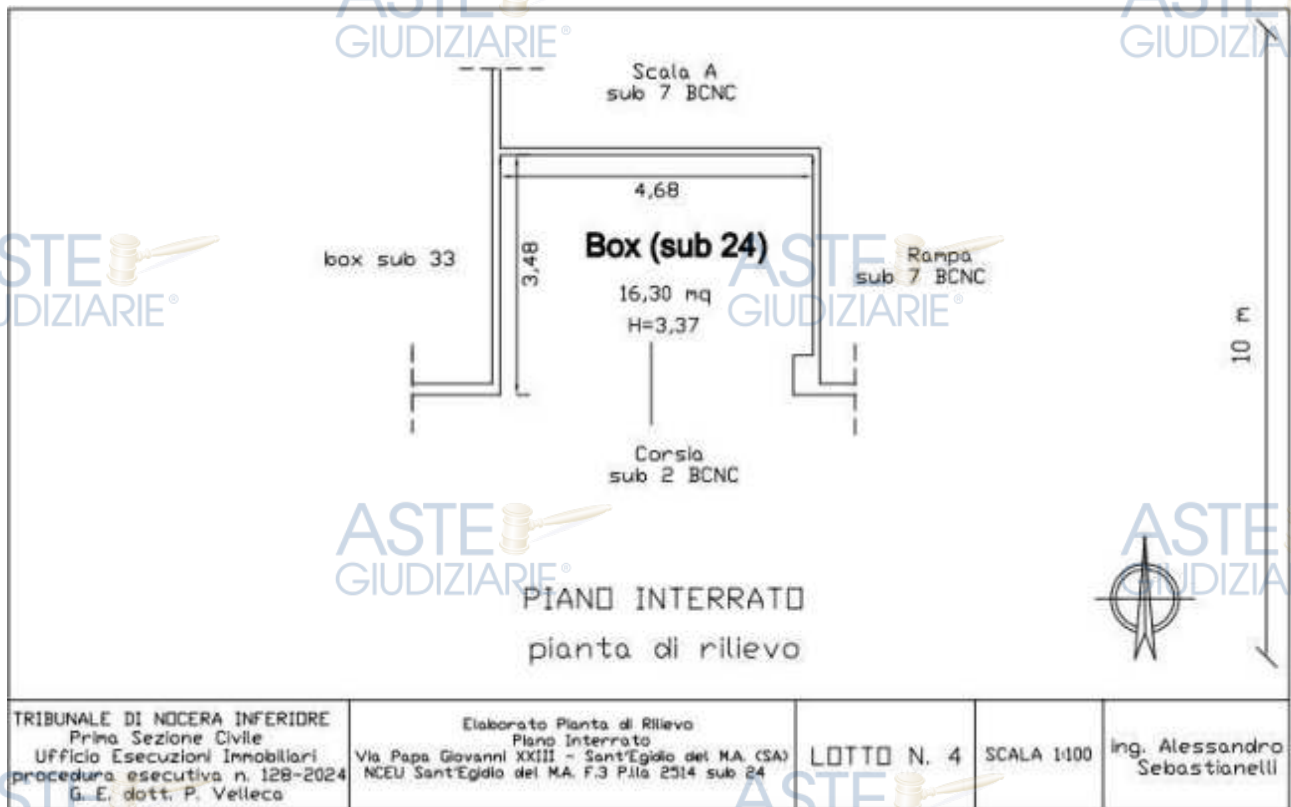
Planimetria stato di rilievo appartamento lotto 4
